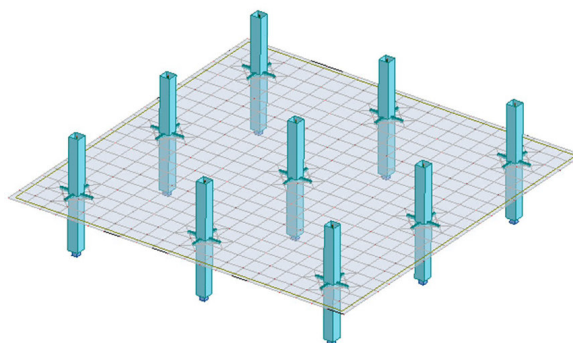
Расчетная схема перекрытия с балочными срезными узлами в расчетном комплексе Robot structural
